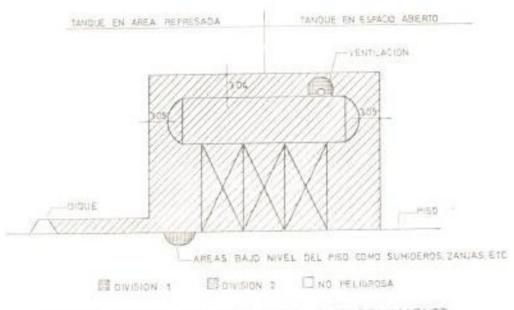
TANQUE ELEVADO PARA, ALMACENAMIENTO.
